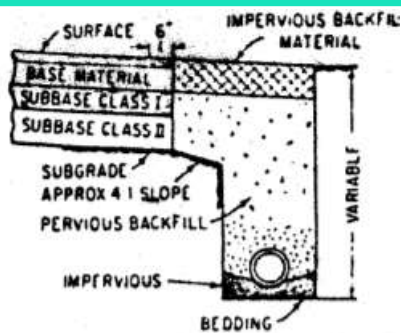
Inlet dan Outlet Drainase pada Shoulder
